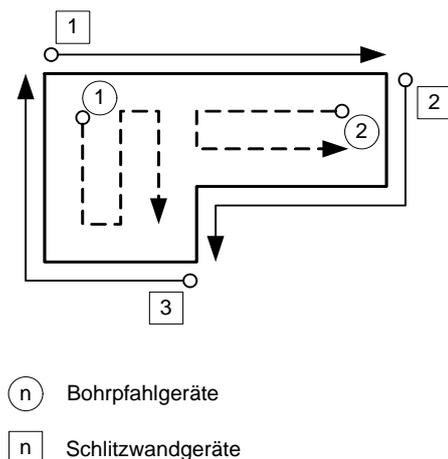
Einsatzplan der Schlitz- und Bohrpfahlgeräte
